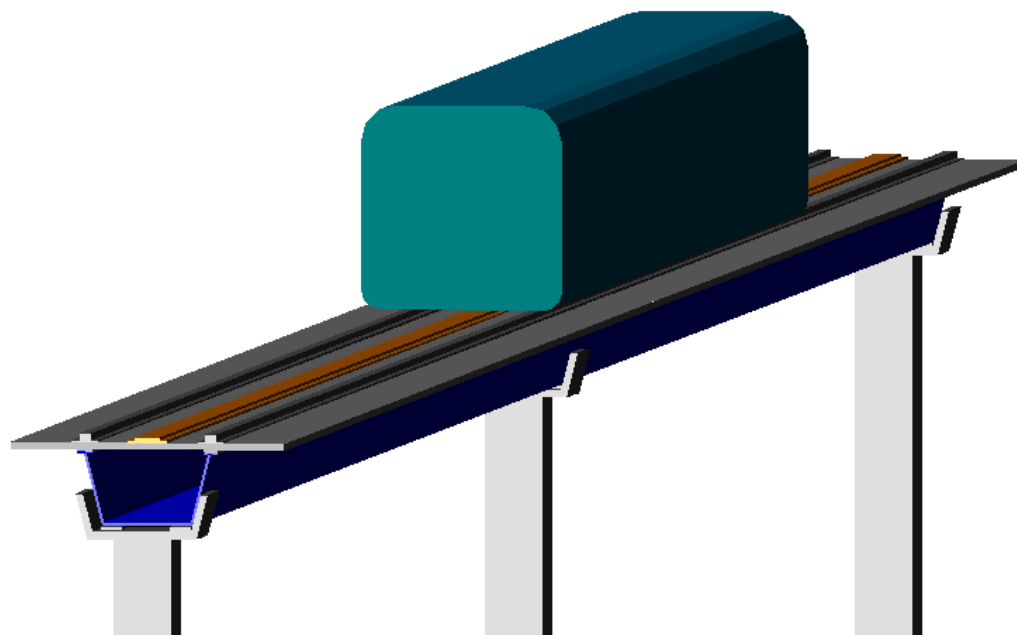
Vista tridimensional, 1ª Opção: vigas em seção trapezoidal e pilares retangulares vazados.
